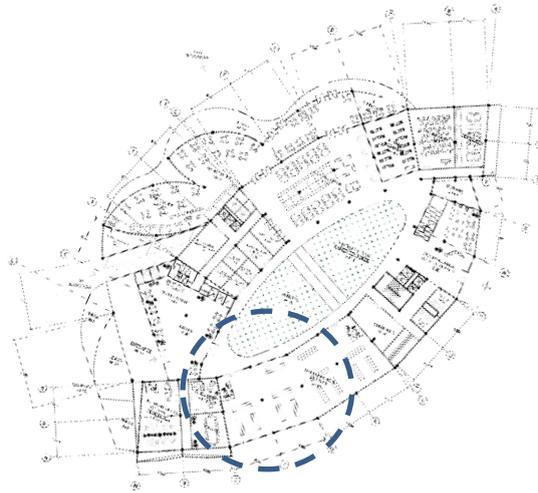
Aplikasi Hubungan Ruang Lantai 1
